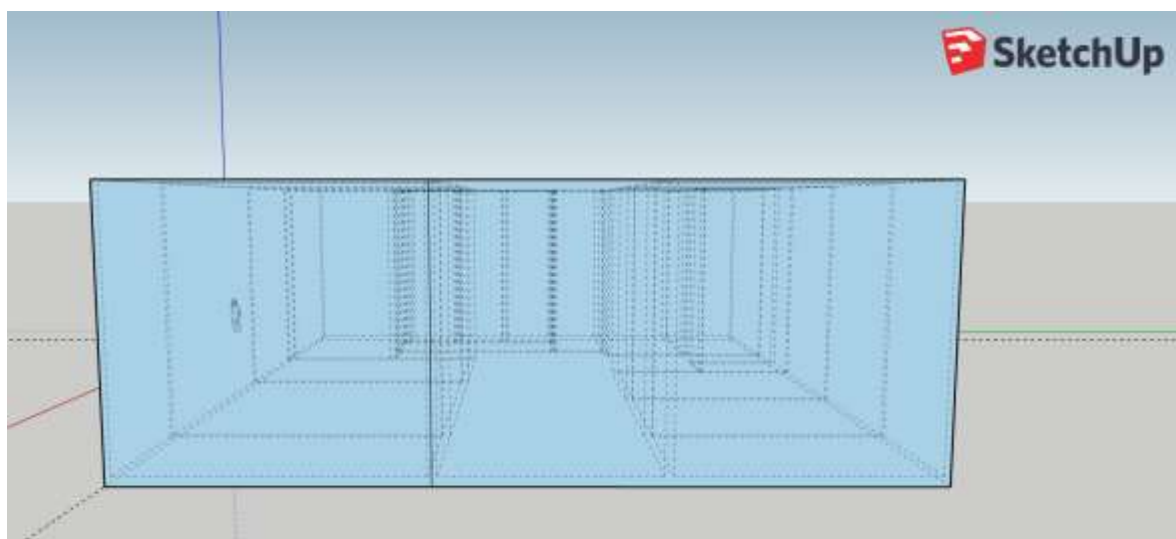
Vista horizontal, segundo ángulo; Imagen: Autoría propia.
